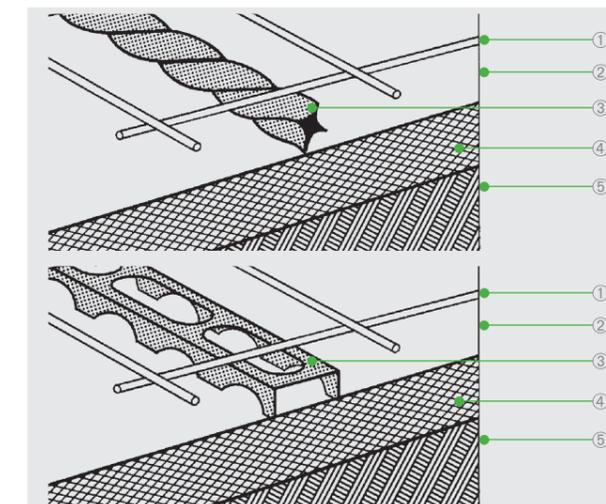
Begehrbarer Flächenabstandshalter aus Faserbeton für die untere Bewehrung und Baustahlgewebeanstützungskorb für die obere Bewehrung der Bodenplatte.
